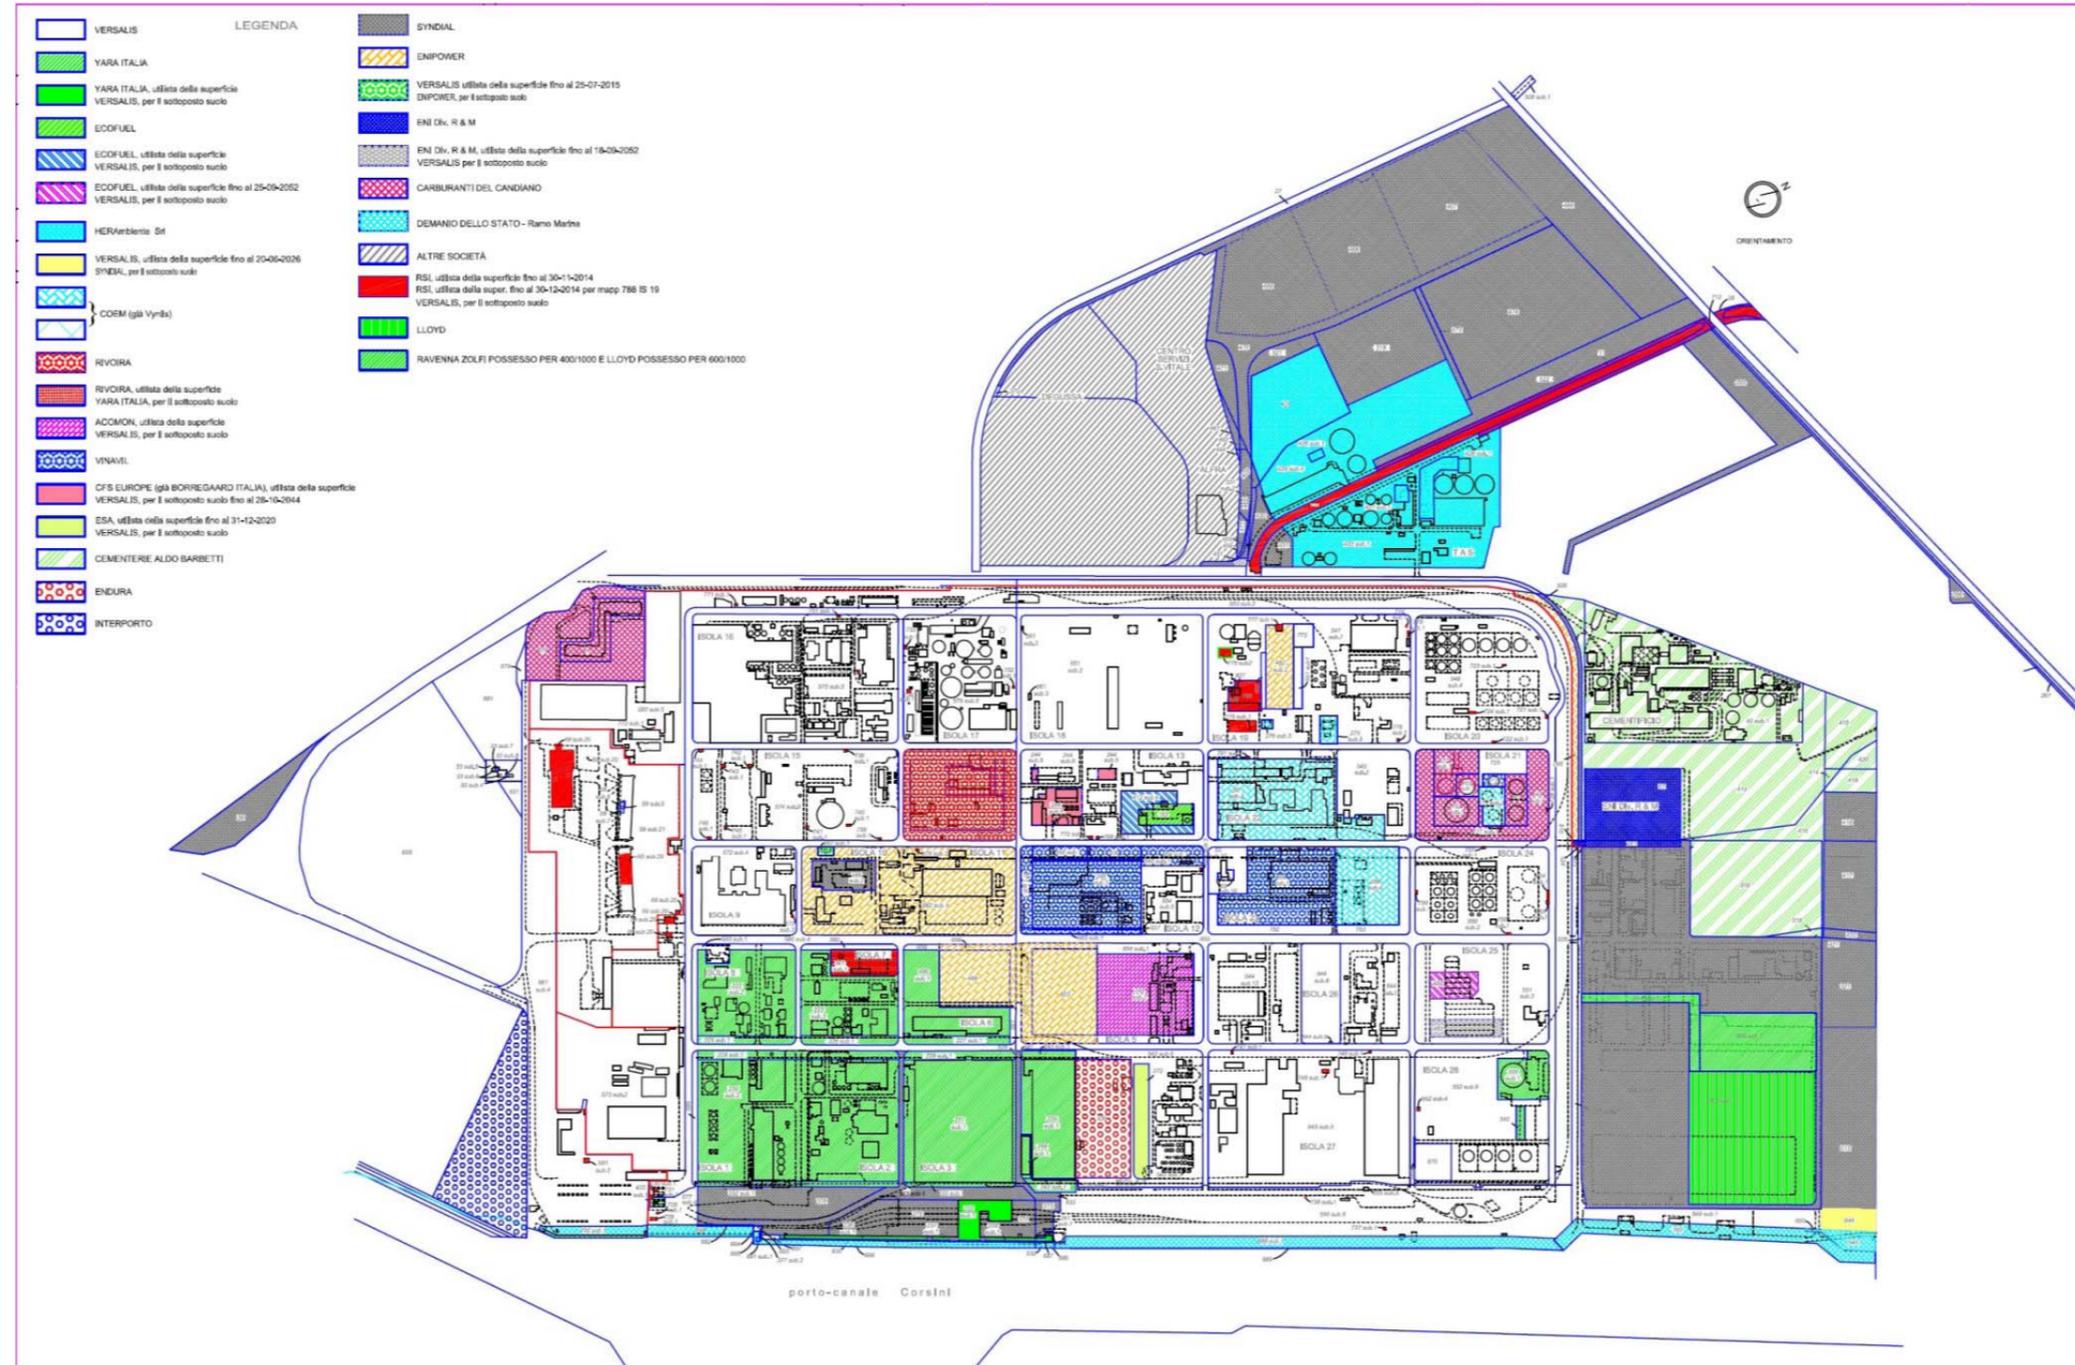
A – Planimetria di Stabilimento con indicazione delle aree EniPower
